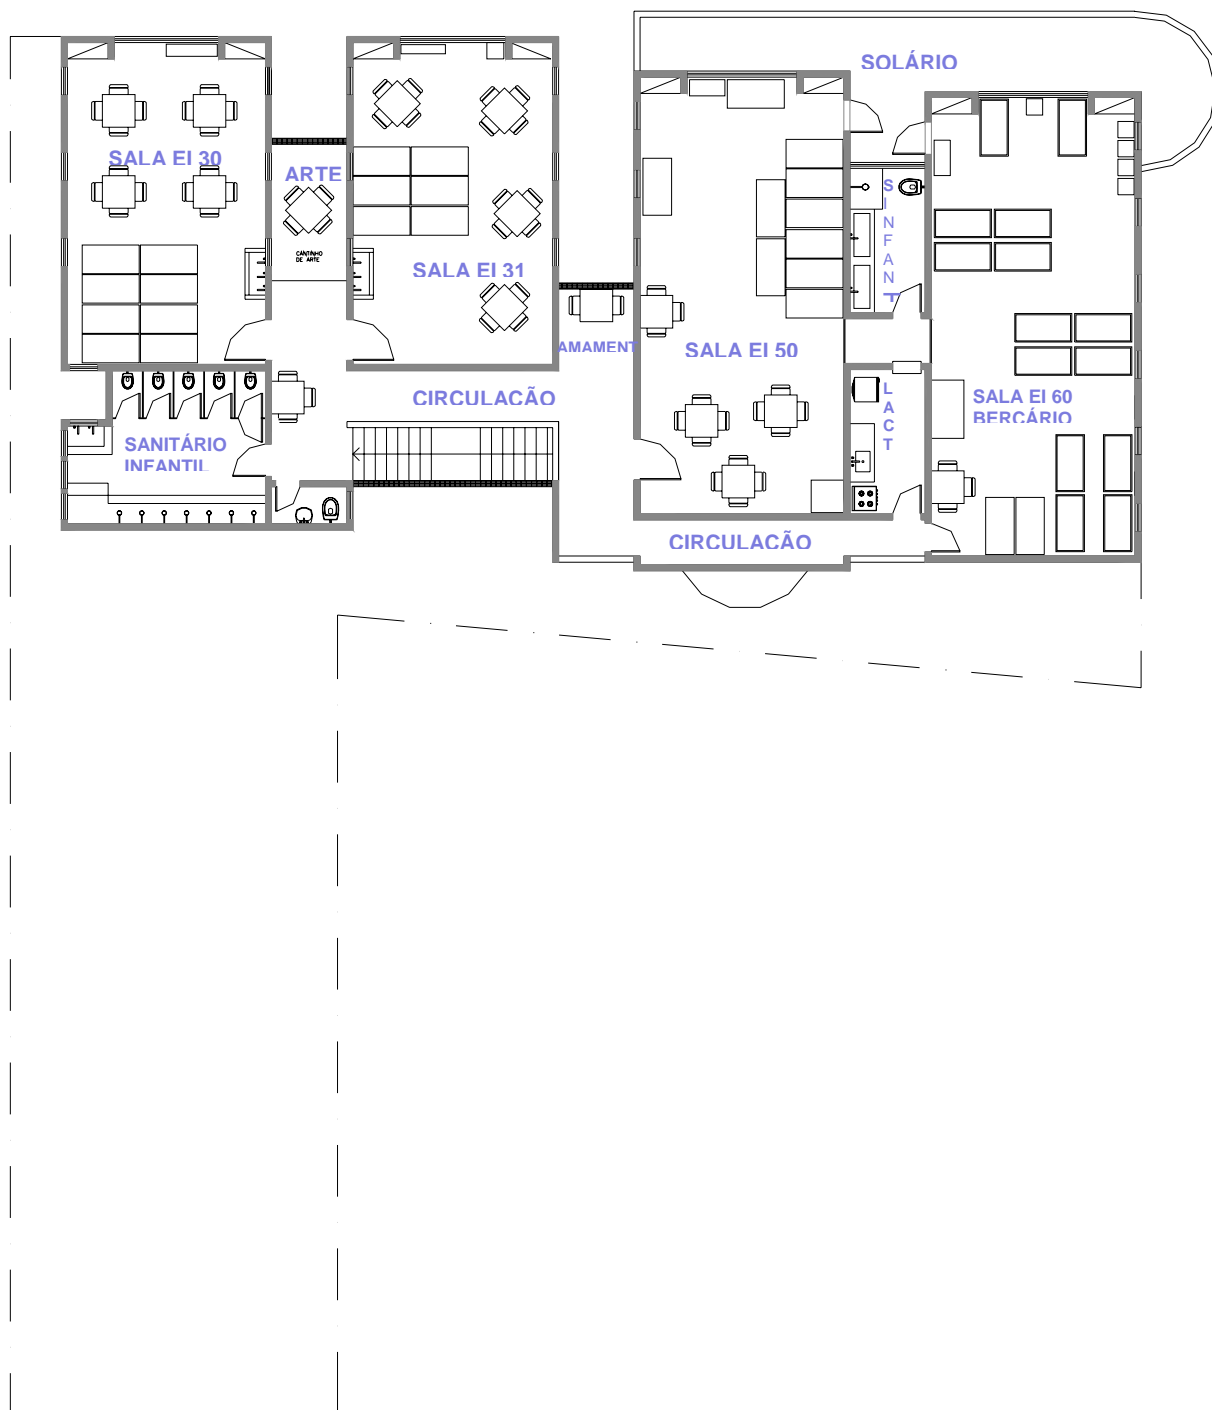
Planta baixa do 2º Pavimento da Creche
